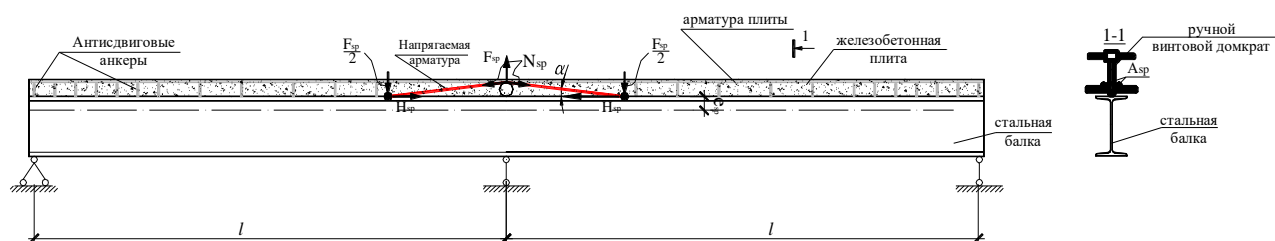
Сталежелезобетонная неразрезная балка с локальным обжатием только на опоре
